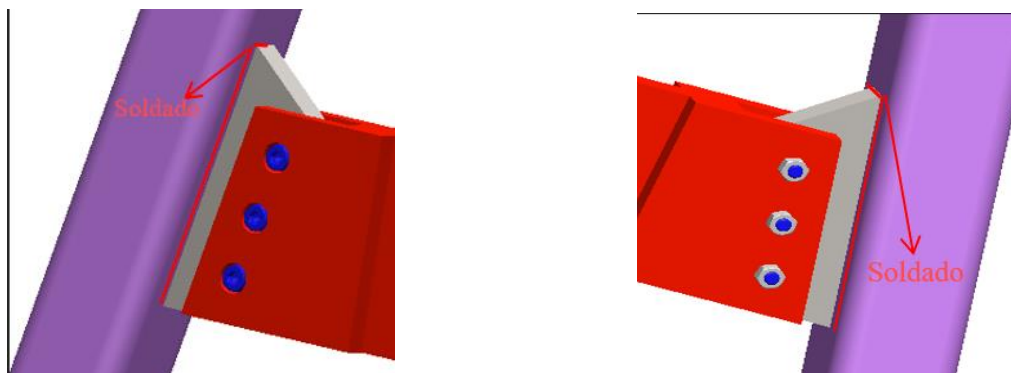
Vistas de soldado pieza N°2 (Fuente 86)
